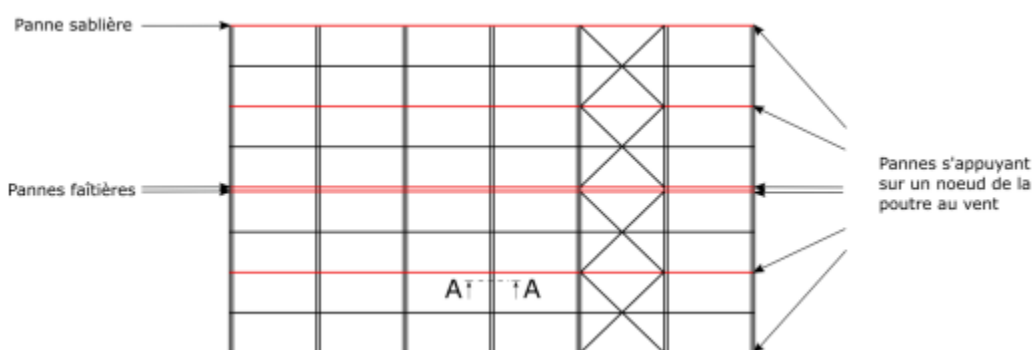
Maintien des semelles de la traverse – Vue en plan
